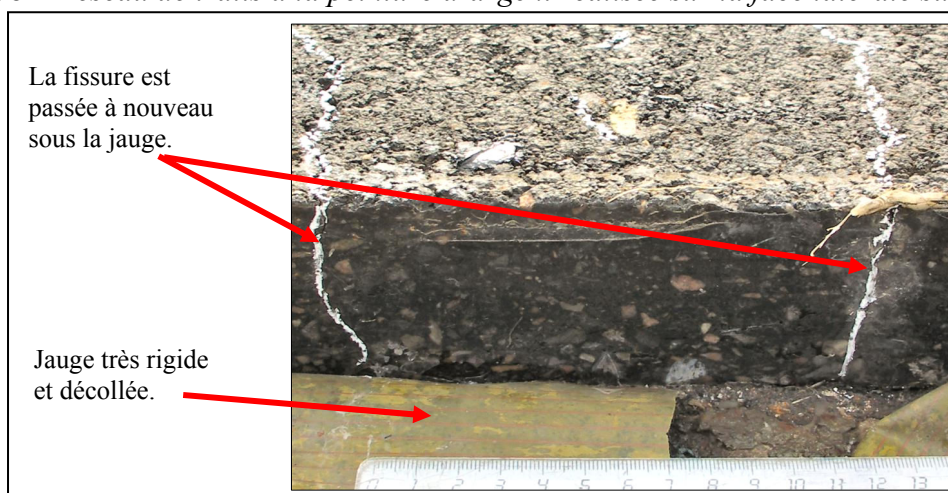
Etat de la nouvelle jauge de 30 cm de longueur après l'essai de fissuration
